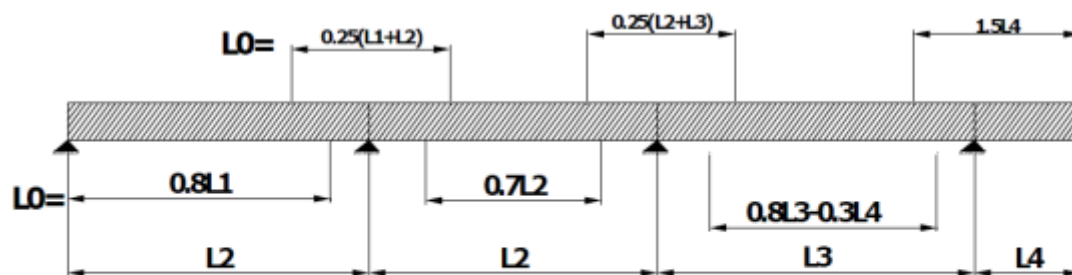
Largeur participante de la dalle dans le cas d'une poutre continue
